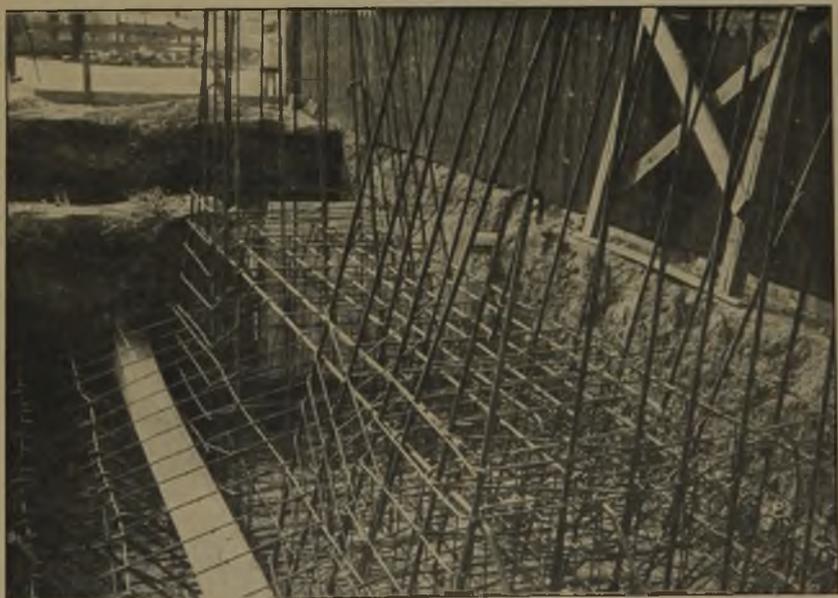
Bewehrung des weit ausladenden Konsolfußes.
